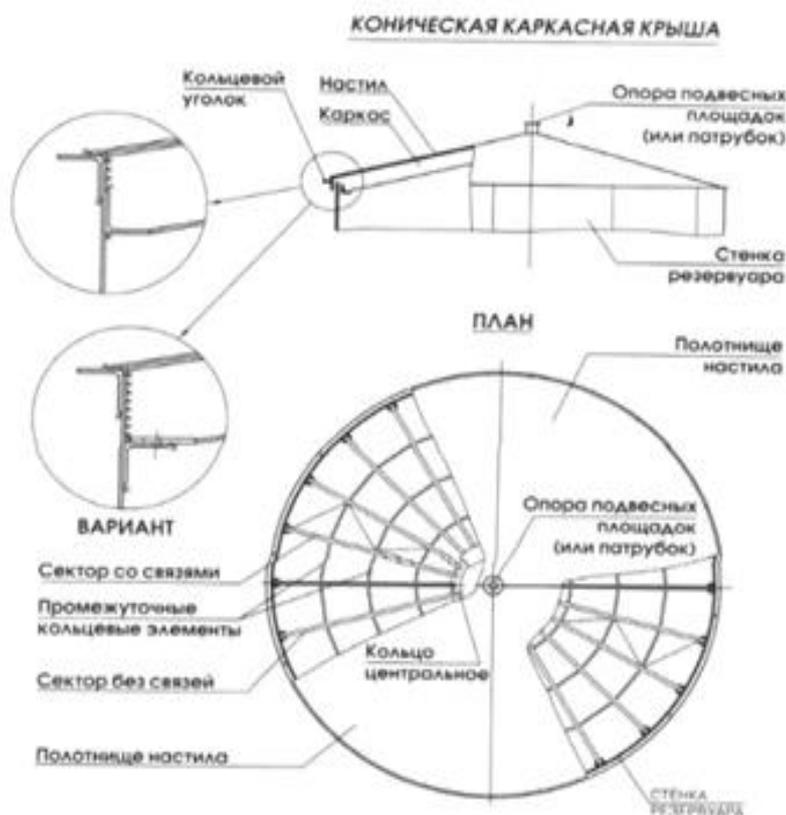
Резервуар вертикальный стальной с каркасной конической крышей
